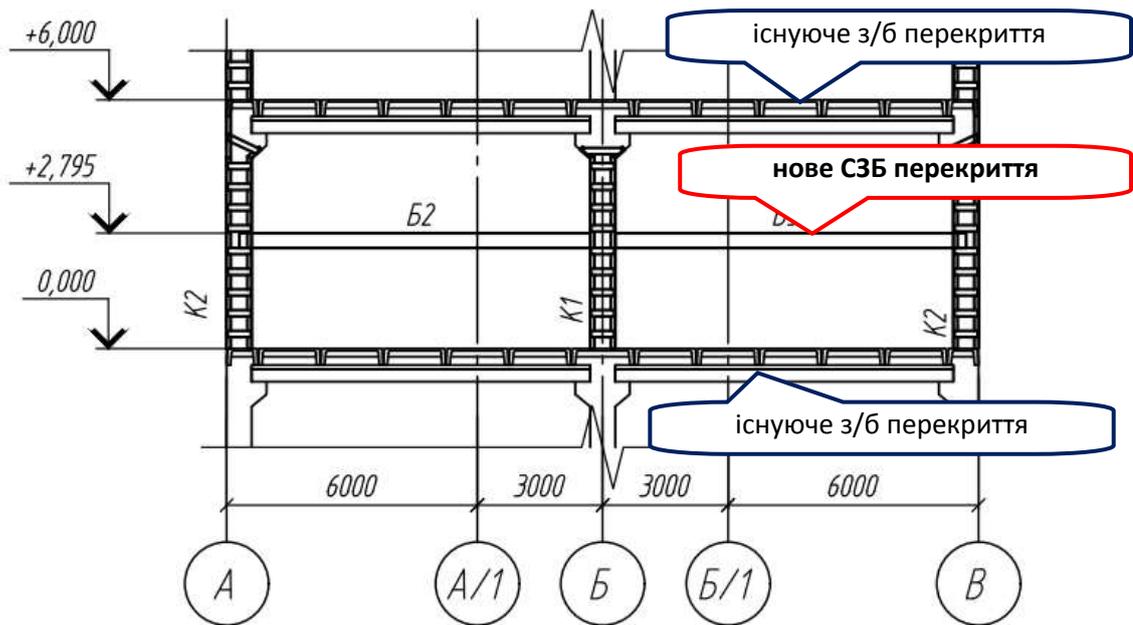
Схема влаштування нових вбудованих сталезалізобетонних перекриттів між існуючими залізобетонними
